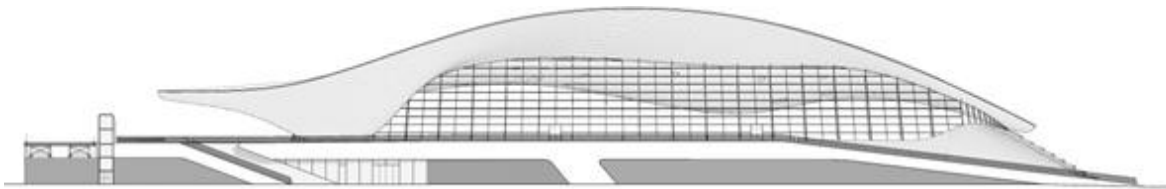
Corte Transversal, Complejo Acuático de Londres. Fuente Archdaily.
